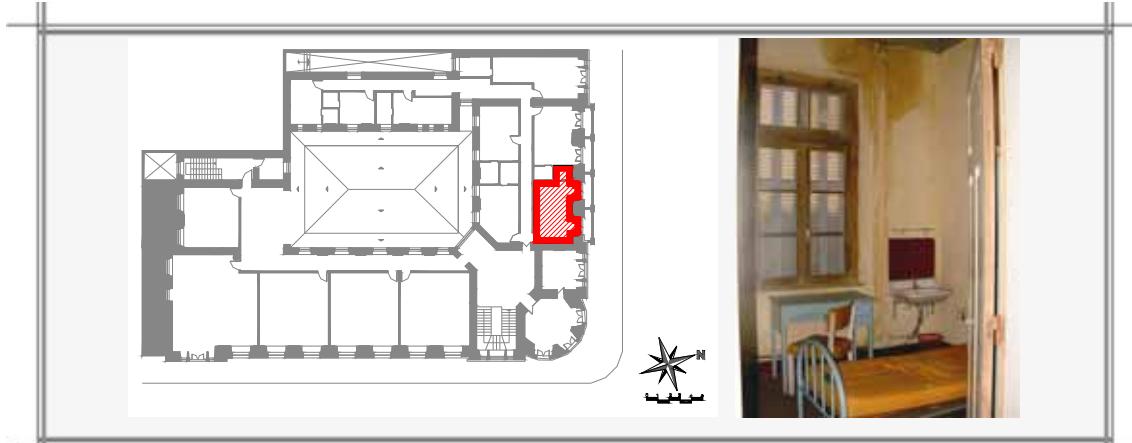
Planta B. 3º Pav., com a localização do Dormitório. Desenho: Cristiane Muller.
